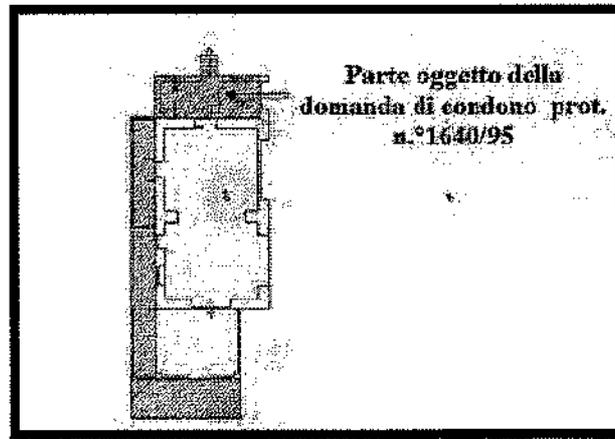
Pianta piano terra (sub 1) – Rilievo eseguito in occasione dei sopralluoghi
